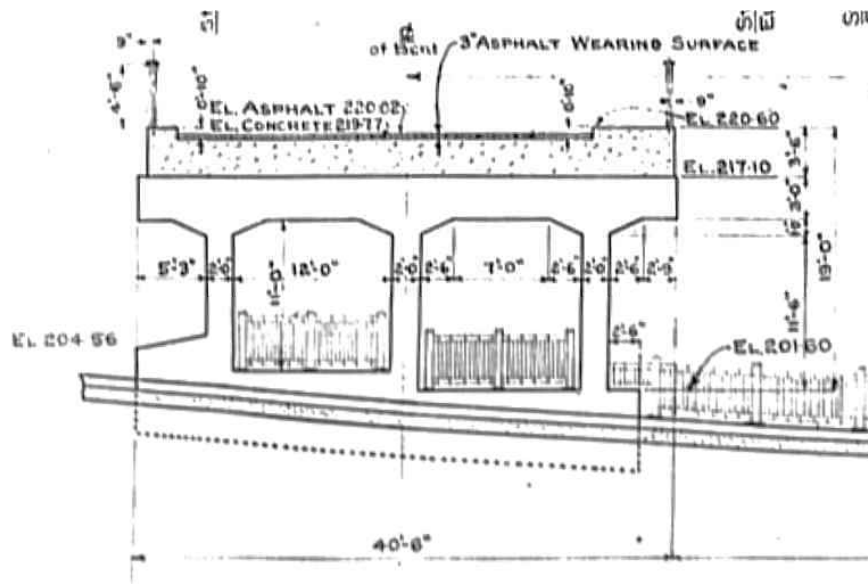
Pont d'étagement routier P.E. 81-5169A – Extrait des plans 5170-1951 - Coupe type du tablier et pile existante
